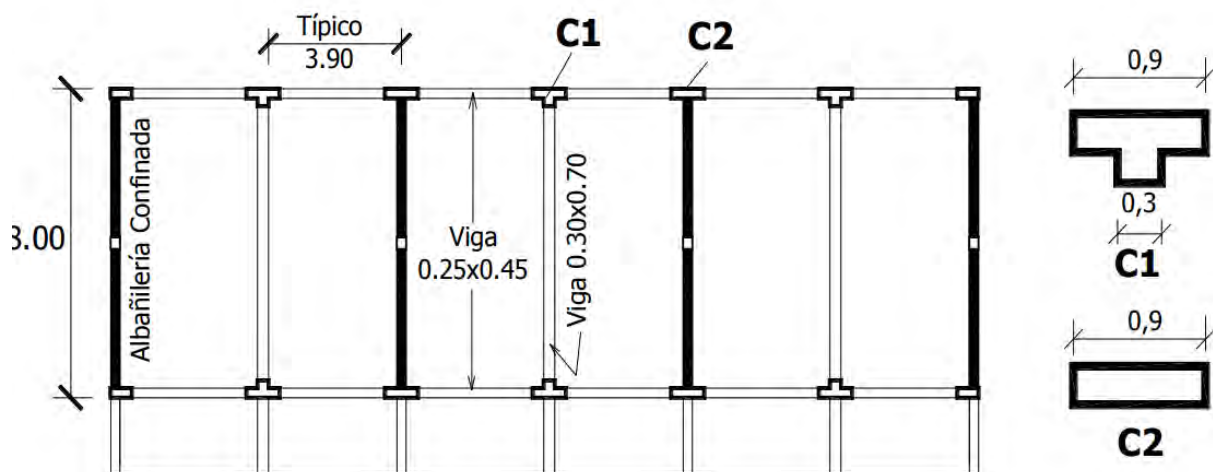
Sistema Estructural Convencional en Planta del Colegio 780 post
